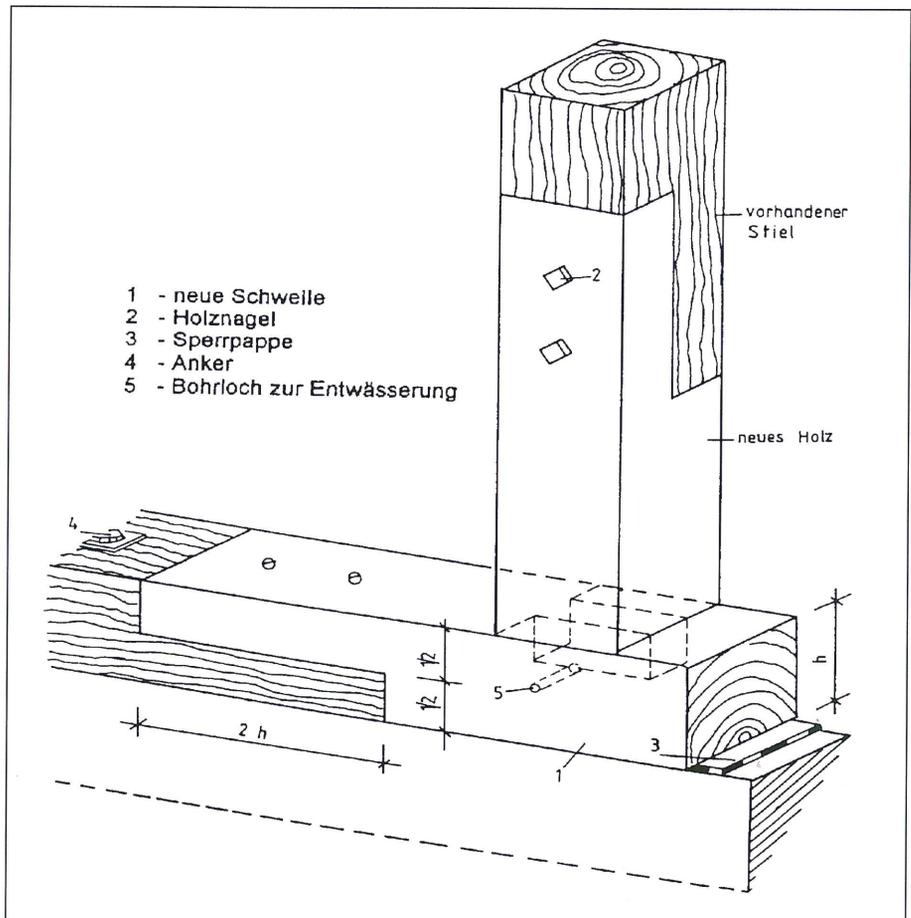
Instandsetzung Schwelle - Stielfuß bei einem Fachwerkhaus, Schwelle mit Fundament verankert.
